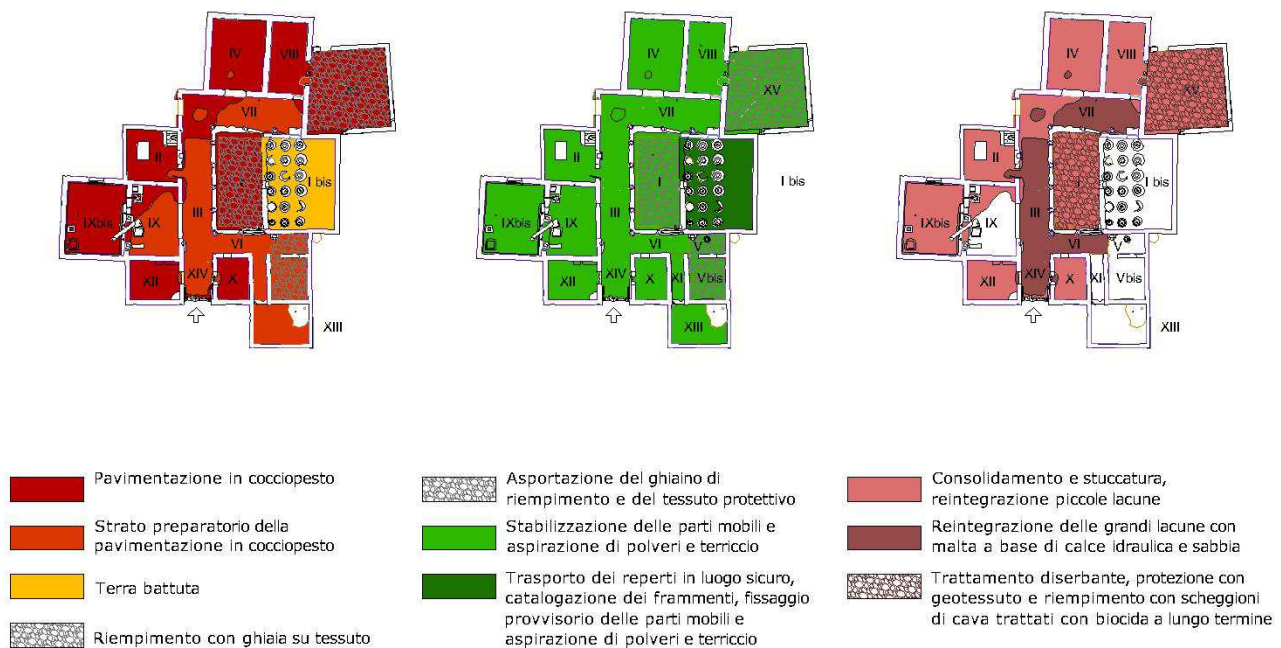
Schema interventi sulle pavimentazioni; da sinistra verso destra: consistenze, interventi preliminari, interventi di restauro
